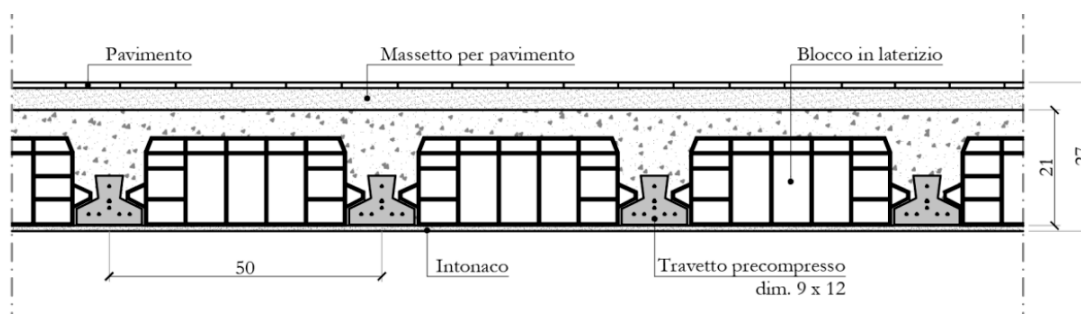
Sezione solaio tipo [cm]
